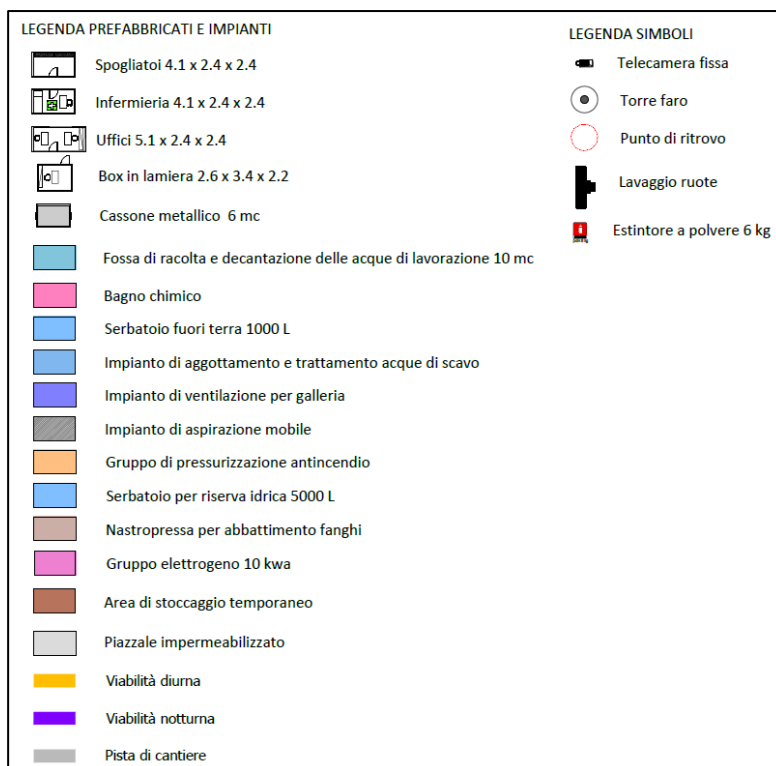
Legenda layout del cantiere operativo all'imbocco sud (CO 01)
